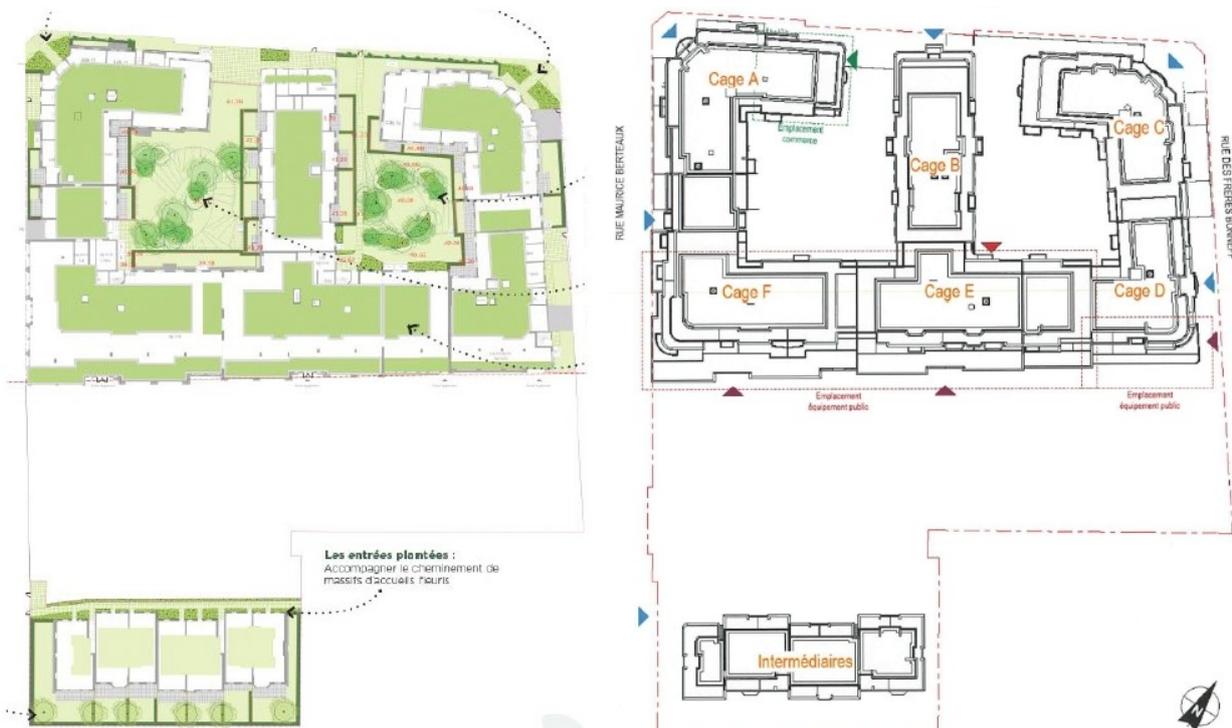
Le projet : plan masse paysager (à gauche) et plan de principe (à droite) (source : étude d'impact, p. 96, et notice PC4, p. 4)
